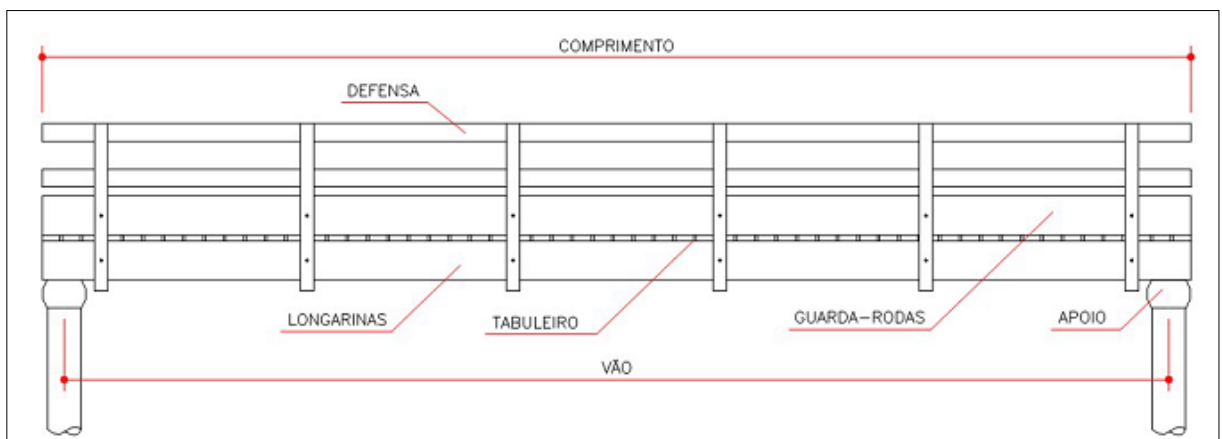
Ponte em Vigas Roliças de Madeira Tratada: Vista Lateral da Ponte.
